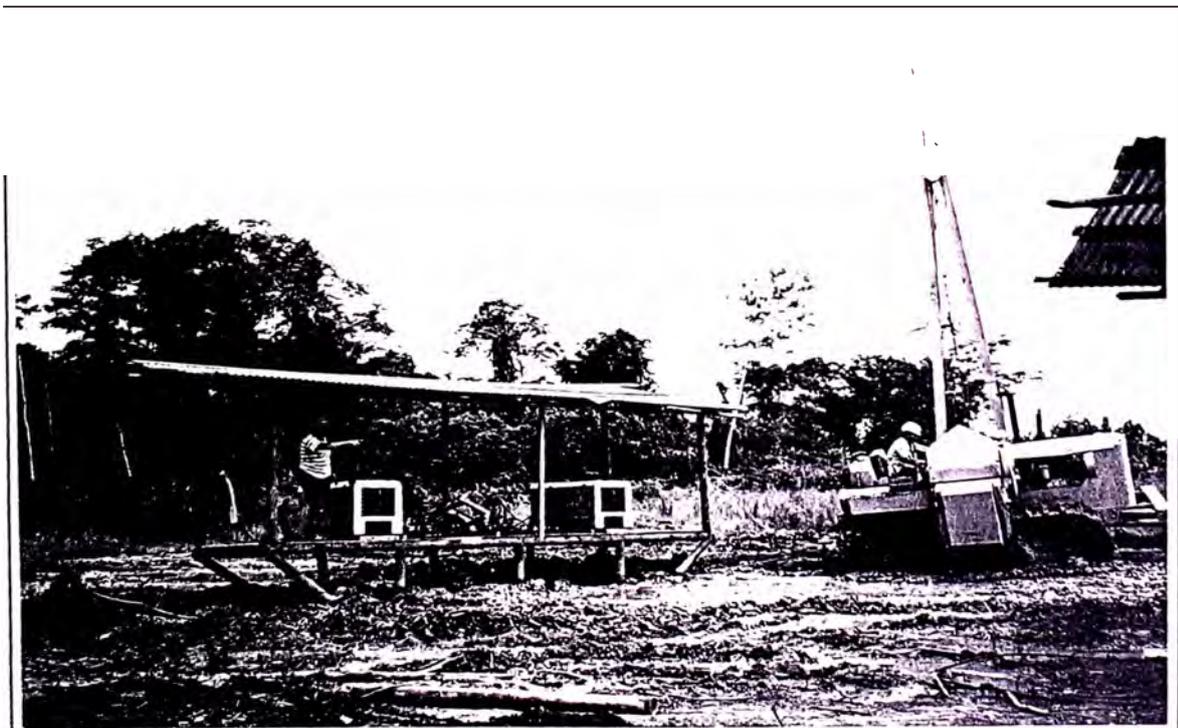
El Side-boom halando trineo de máquinas de soldar 3 y 4.
